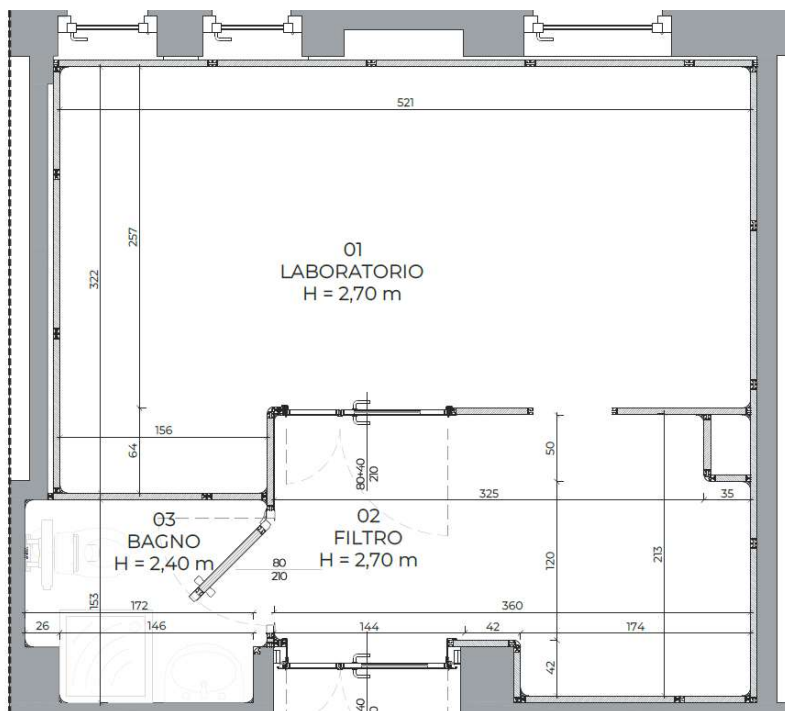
Planimetria Laboratorio BSL3 - Progetto
